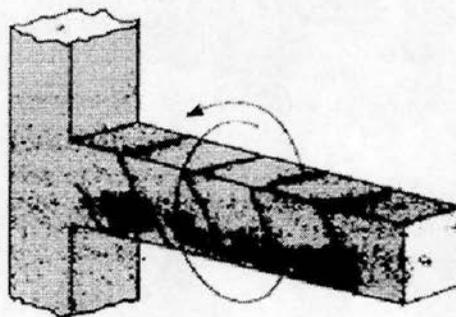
Rotura del concreto a compresión debido a la torsión
